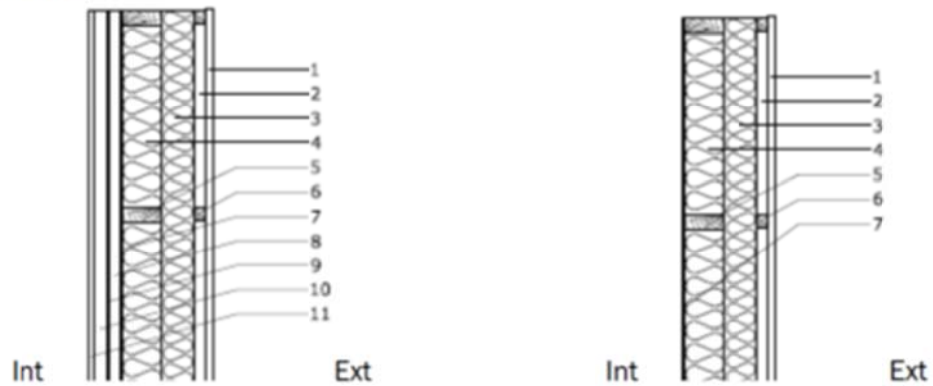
Sección descomposición fachadas. Fuente: 1AMP_CD_2010-09-22
